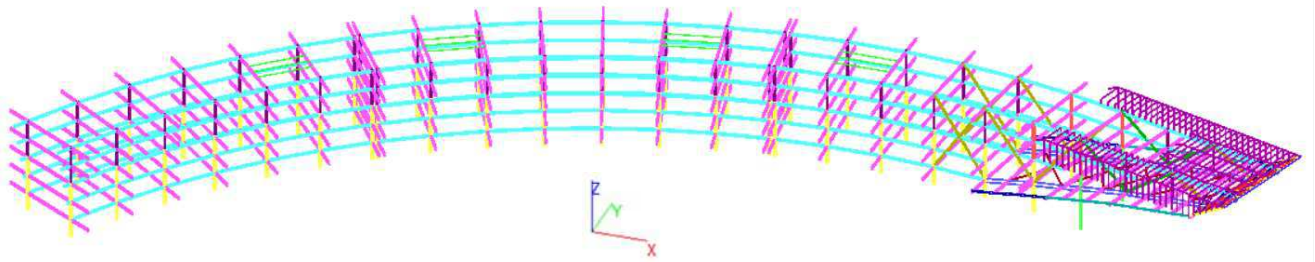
Расчетная схема металлического каркаса здания в системе SCAD
